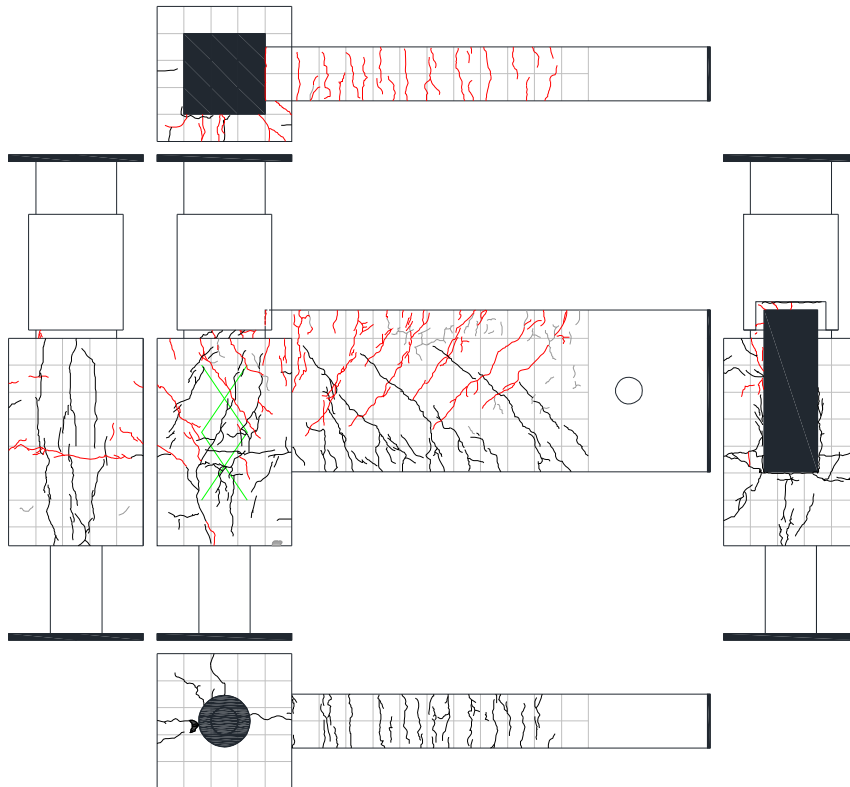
試験体 D-4 ひび割れ状況 (5Cycle)
